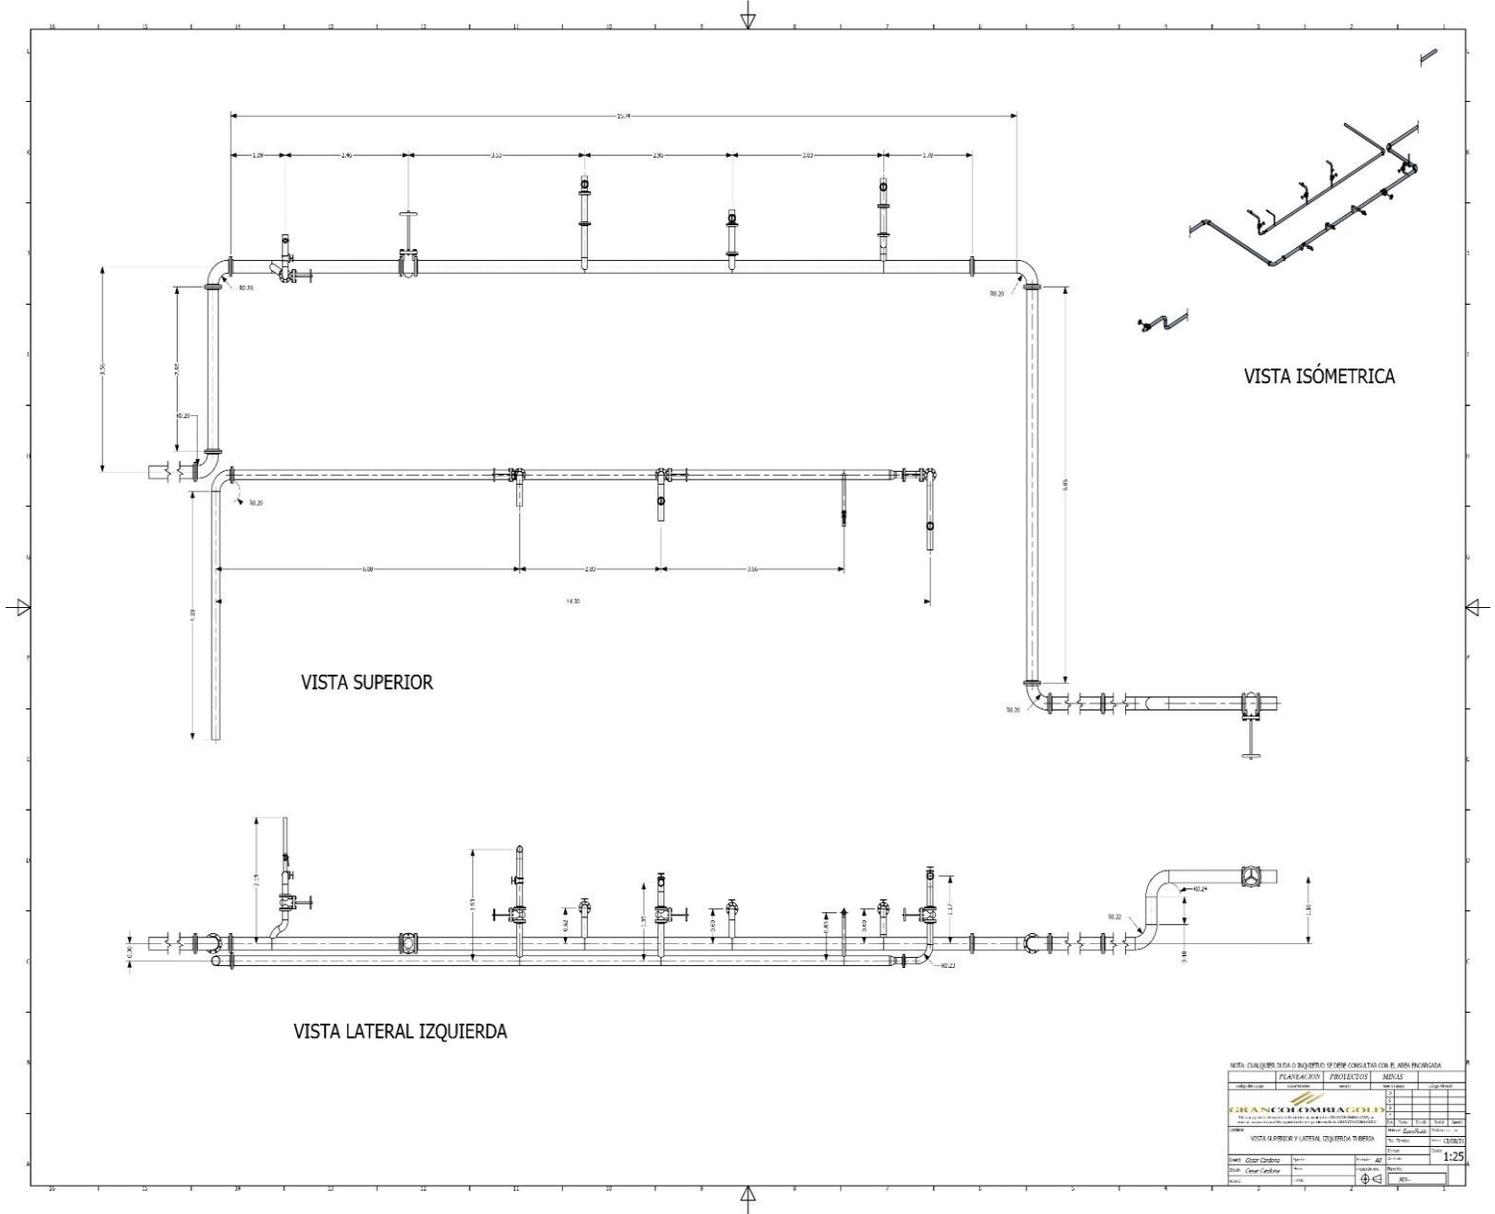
Detalle tubería sala de compresores mina El Silencio
